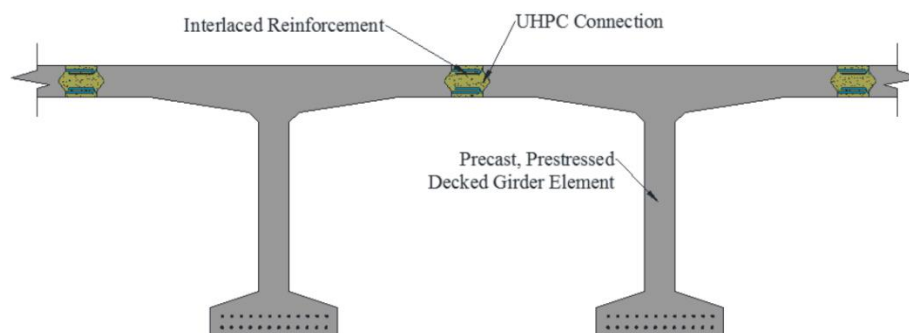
Ligações realizadas com UHPFRC entre elementos de vigas pré-fabricadas e pré-esforçadas com painéis pré-fabricados [19].
